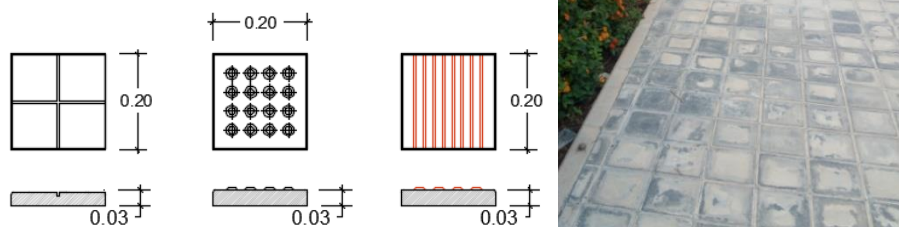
Pavimento de baldosa previsto en las aceras de la actuación.
